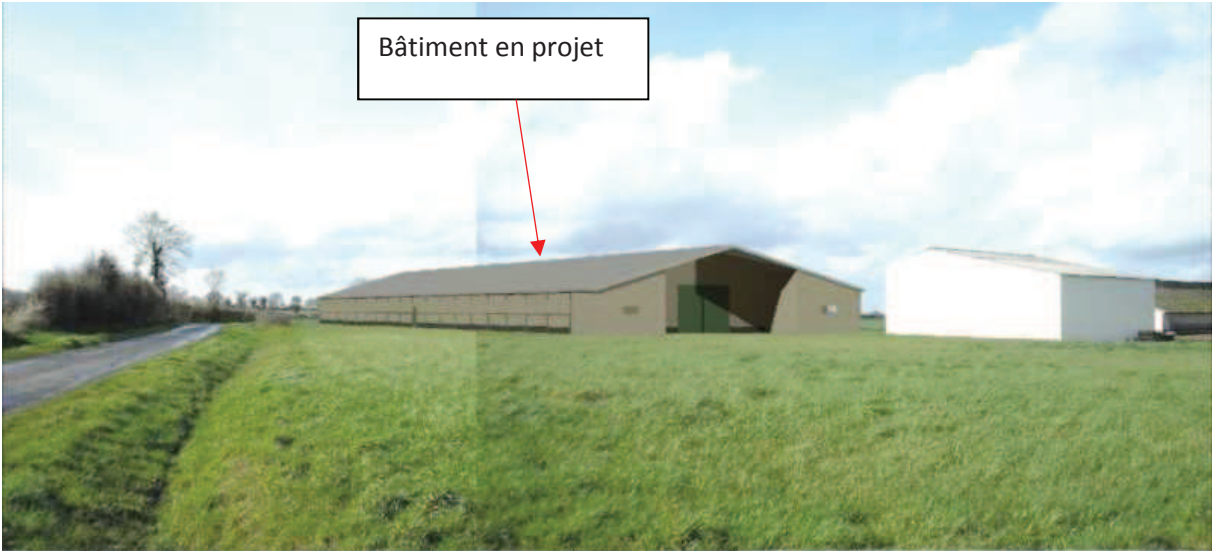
Vue de l'Ouest sur l'emplacement du bâtiment
